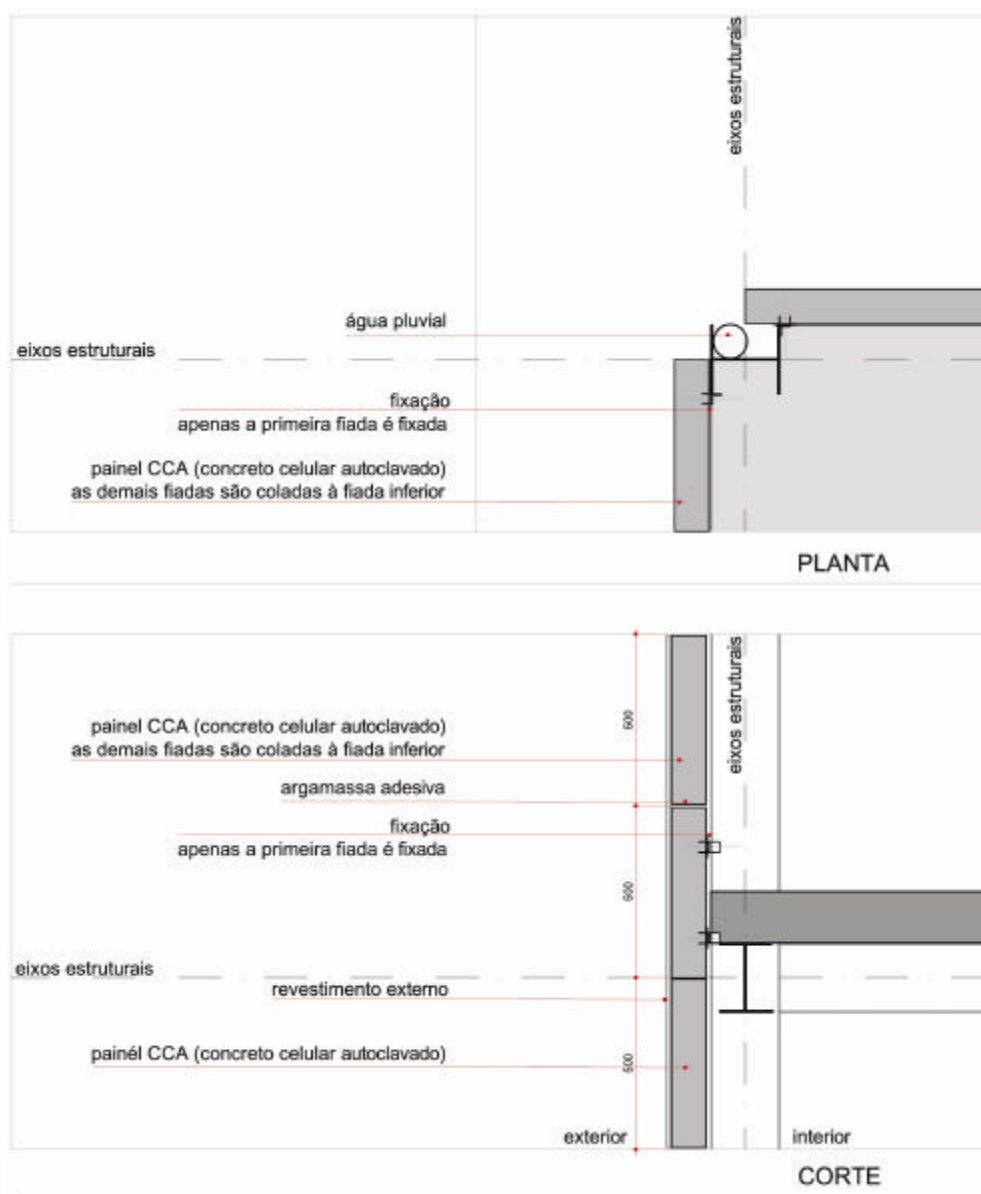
Painel cortina em concreto celular autoclavado. Placas dipostas horizontalmente.
